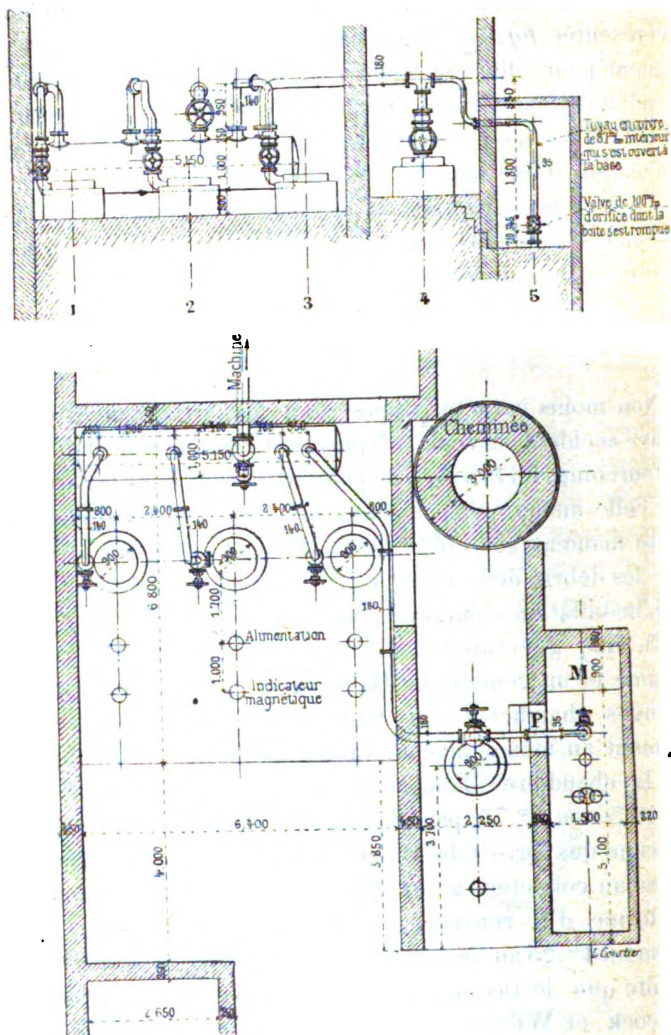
et 5. — Coupe et plan de l'installation, à Tourcoing.
